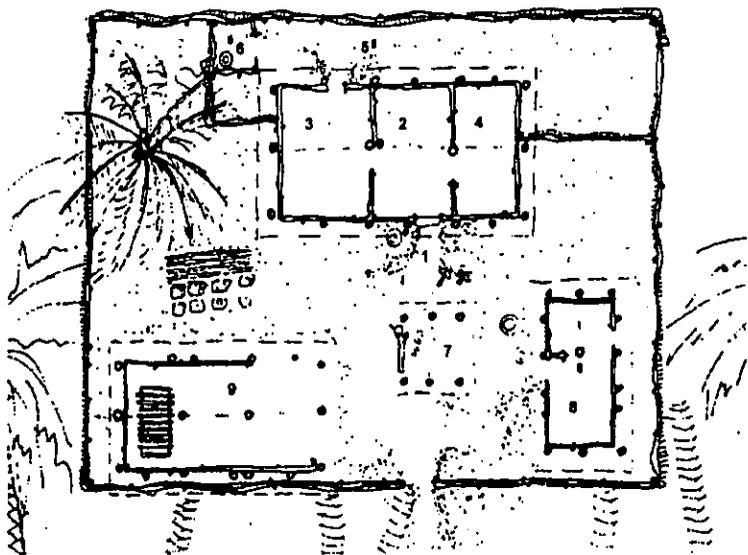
Planta de barrio en un pueblo avikam
